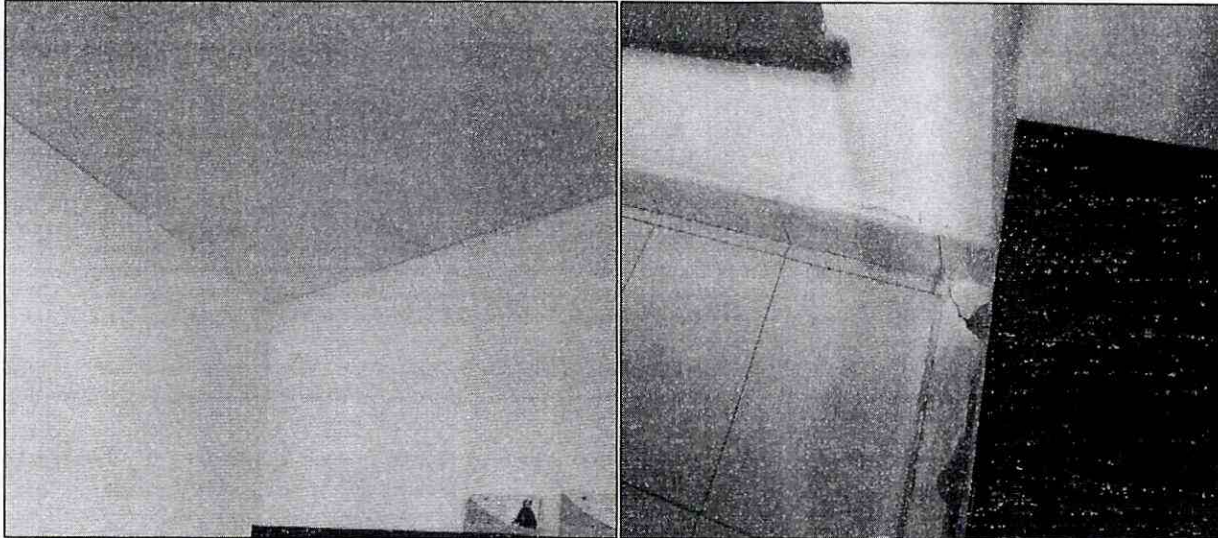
y 4. Vista de las grietas en muros divisorios de la edificación de la Calle 128 B No. 57 C - 06, en el Sector Catastral Prado Veraniego Sur, de la Localidad de Suba
